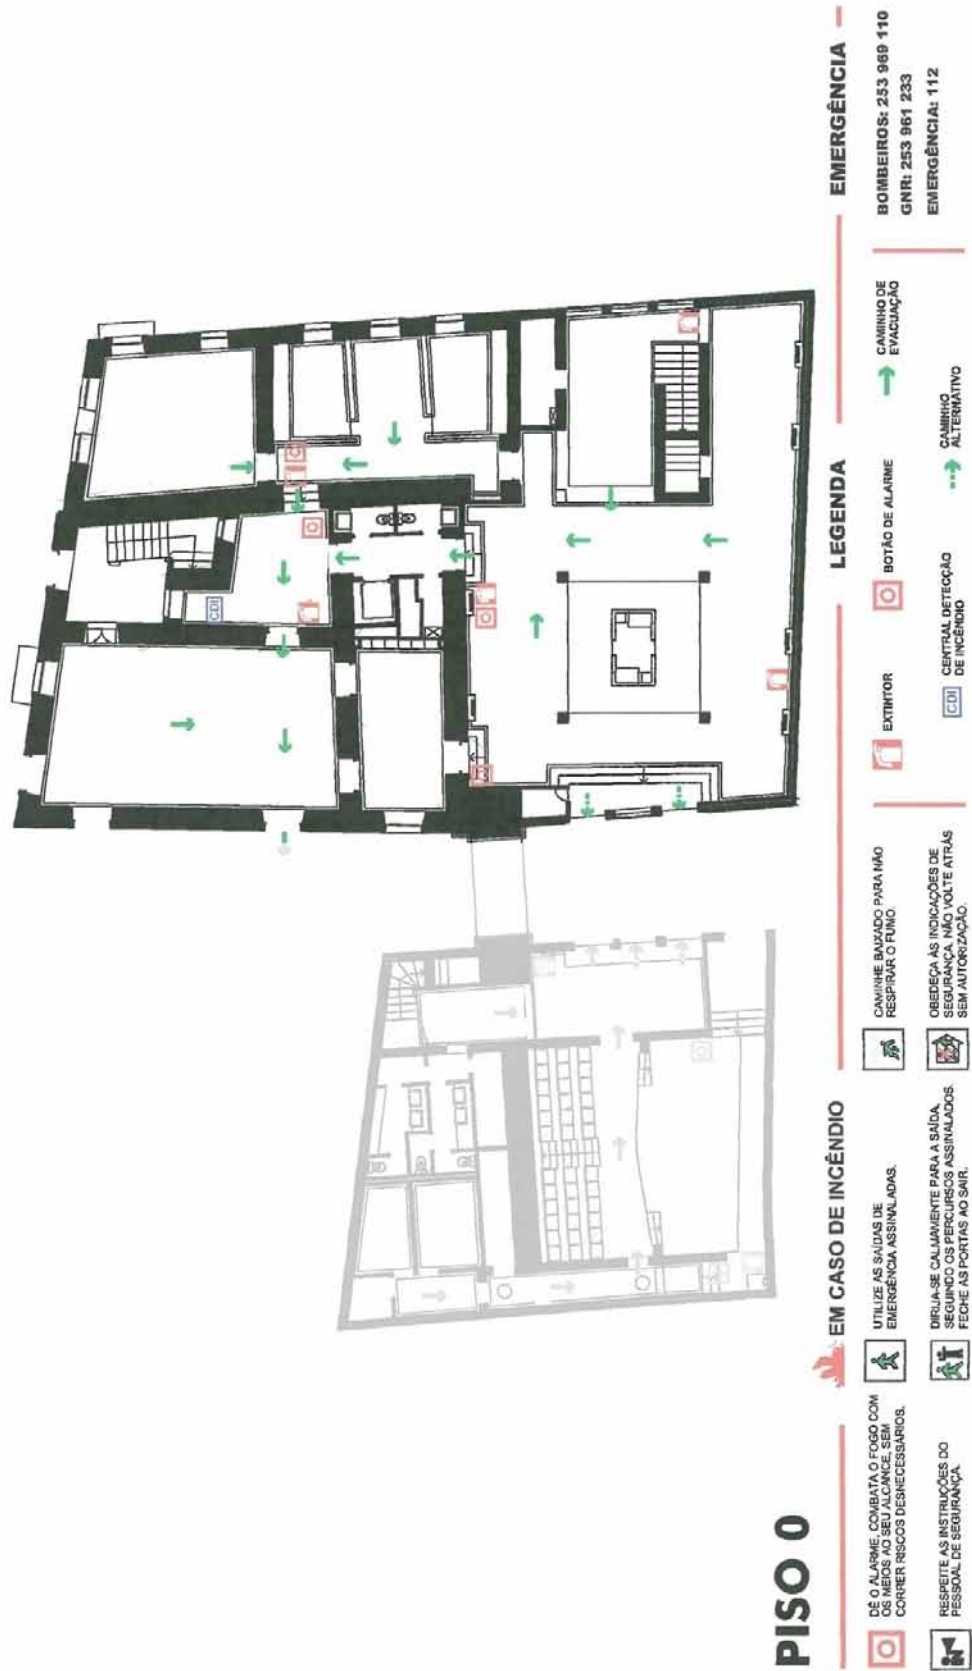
Planta de Emergência Existente (Piso 0)
